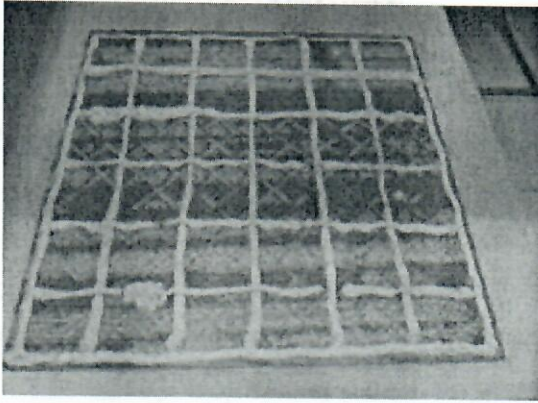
Aplicação de selante para assentamento de placa cerâmica.
